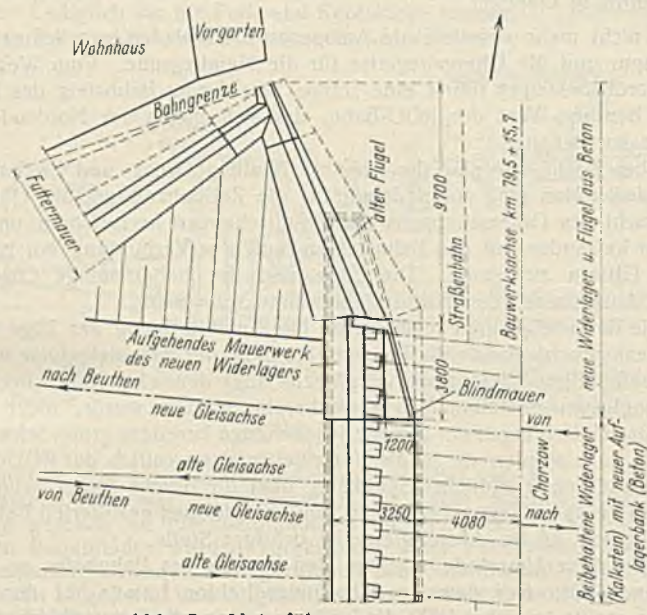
Unterführung der Königshütter Chaussee. Grundriß.
